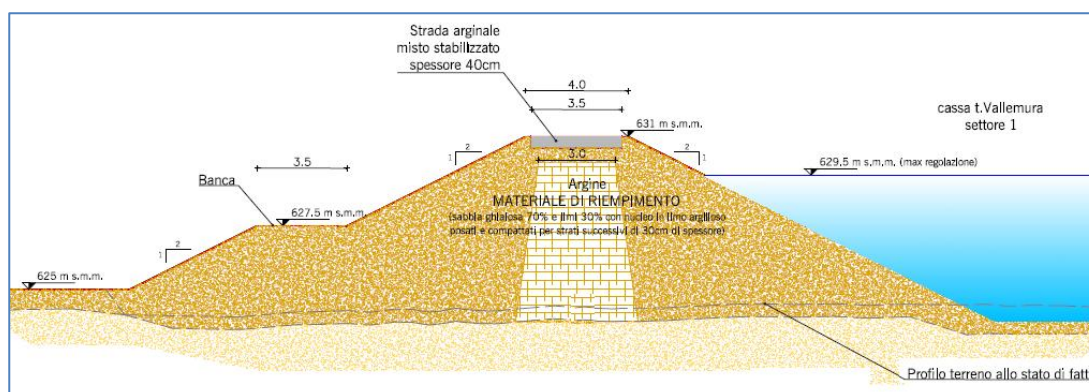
Sezione tipo dell'argine della cassa (setto 1).
